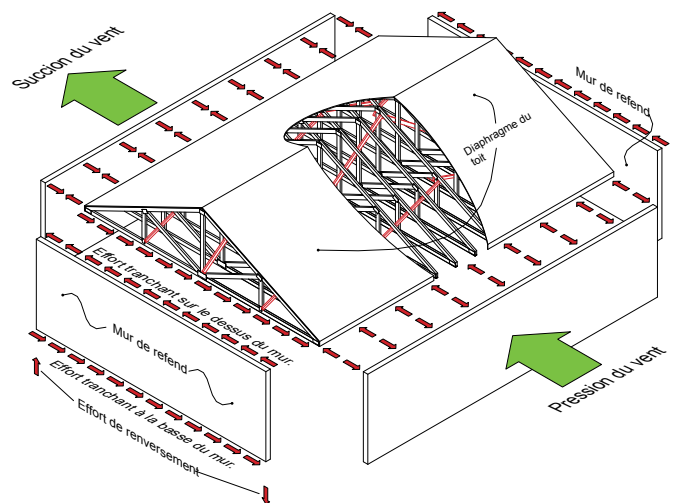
• Charges latérales appliquées parallèlement aux fermes
